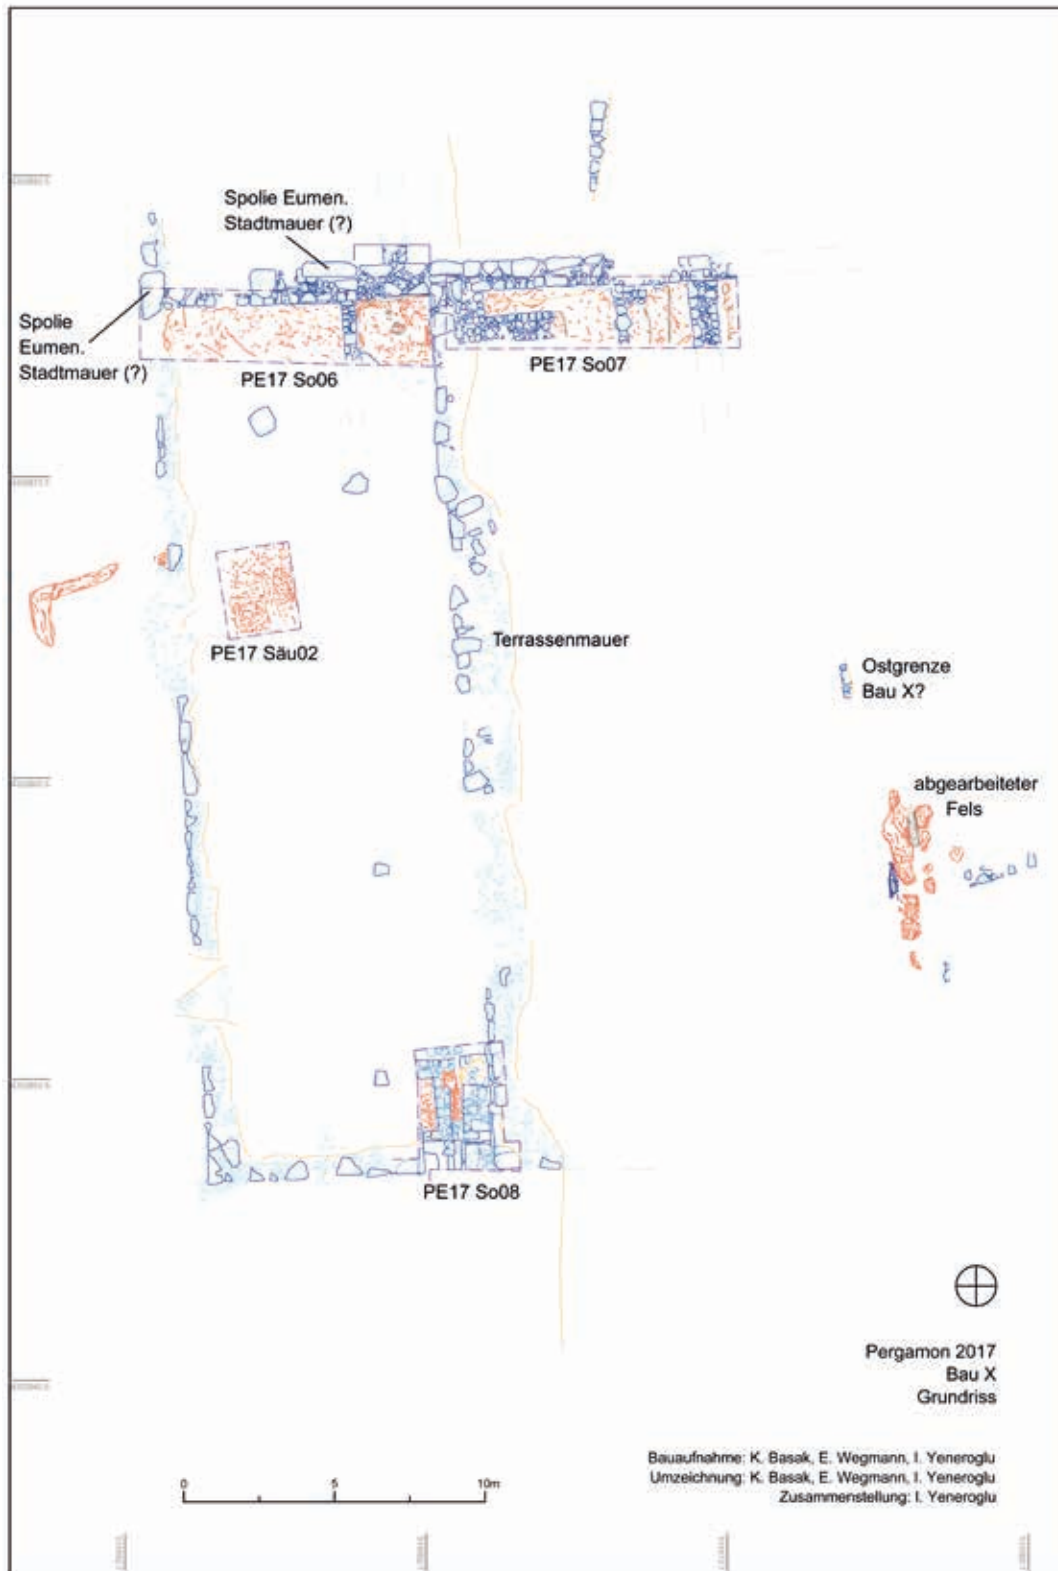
Pergamon, Stadtberg. Westhang, Bau X. Grundriß (M. 1 : 250)
